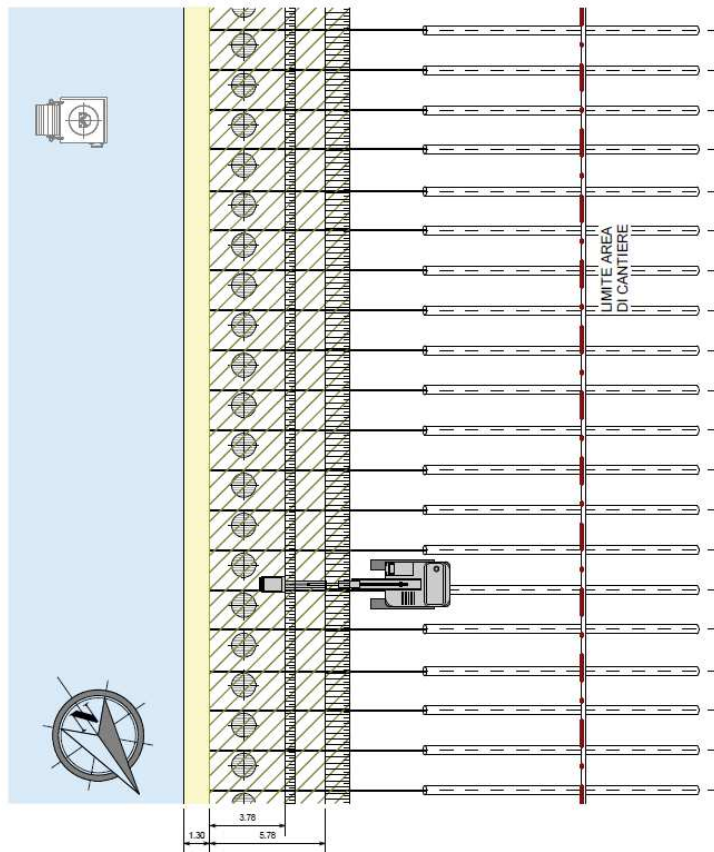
Planimetria con indicazione della demolizione e dello scavo
